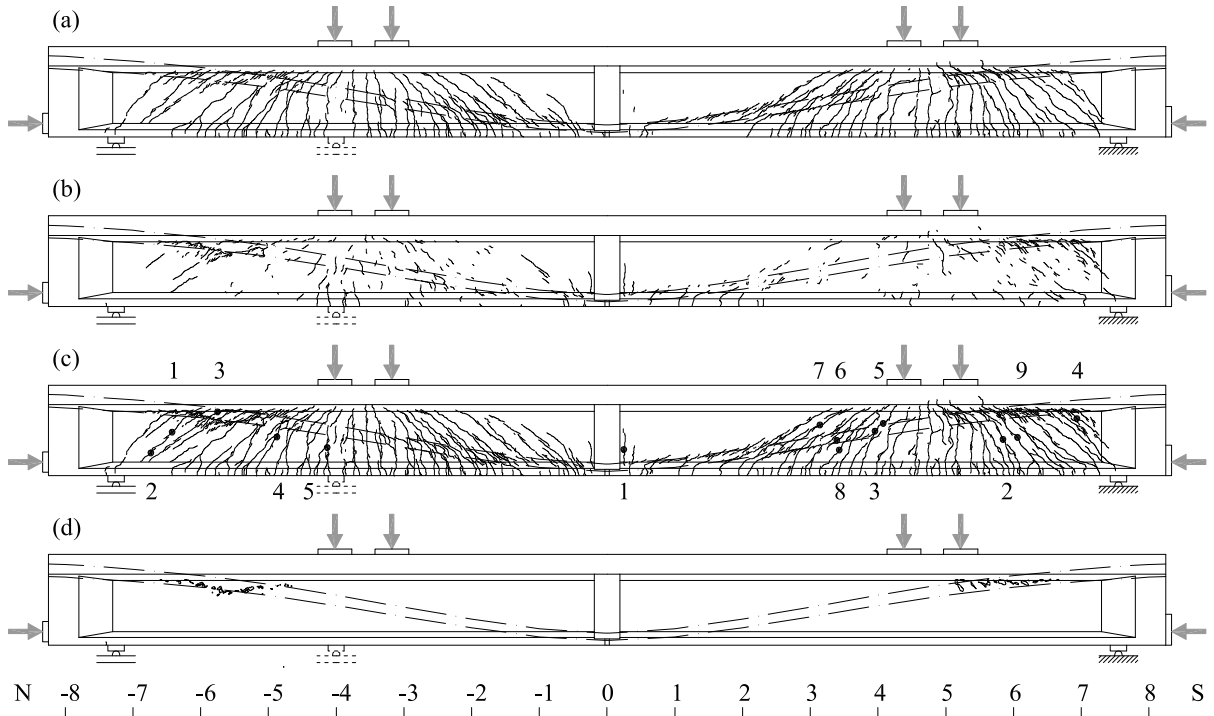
Fissuration de l'essai SH4 ; la partie Nord montre l'essai SH4a, la partie Sud l'essai SH4b : (a) palier 2/9 (b) fissuration additionnelle jusqu'à la rupture (c) rupture (d) éclatement du béton immédiatement après la rupture
